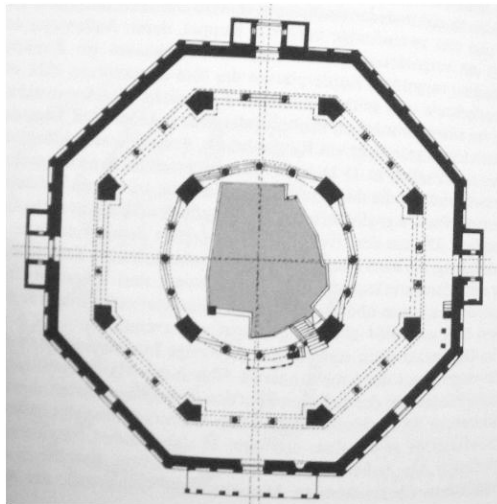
Grundriss, Felsendom, 688/9-691/2.
